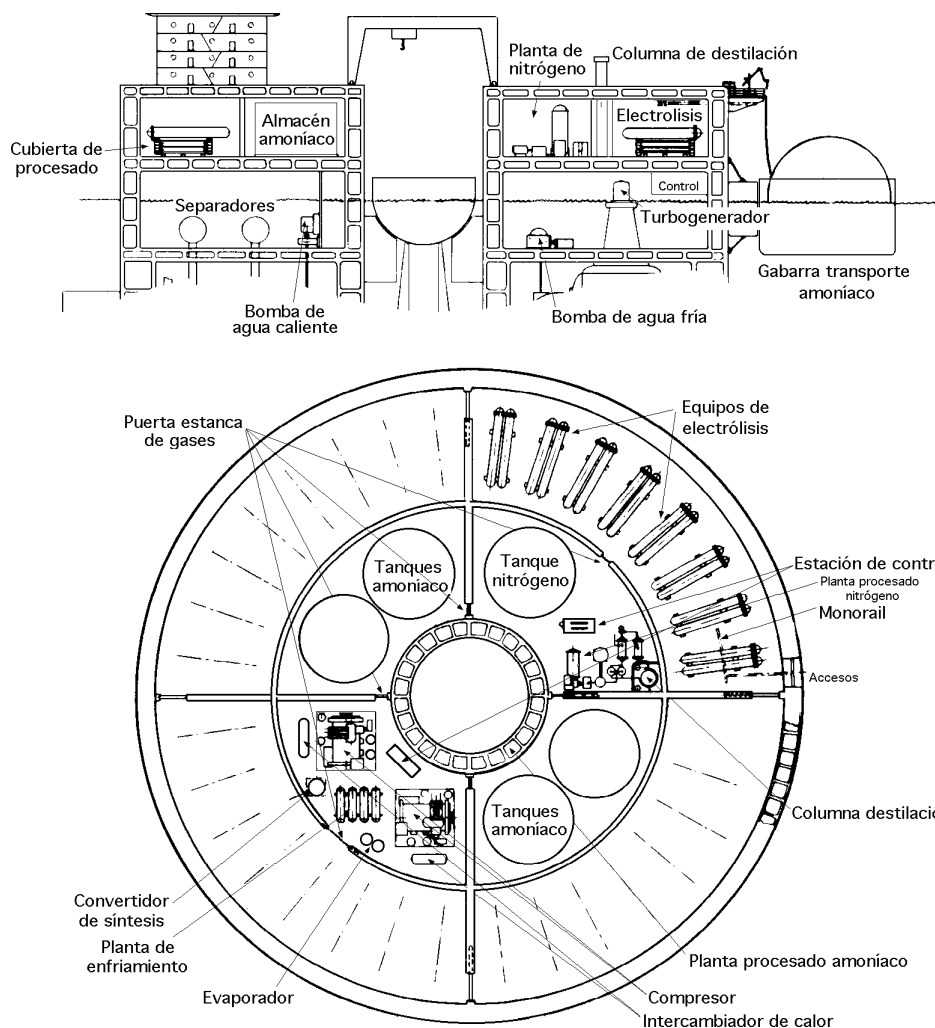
Vista seccionada de la planta de amoníaco de una central C.E.T.O.
